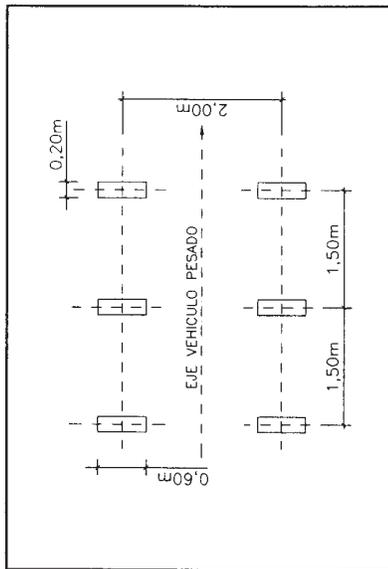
PLANTA CROQUIS DE UN VEHÍCULO PESADO
